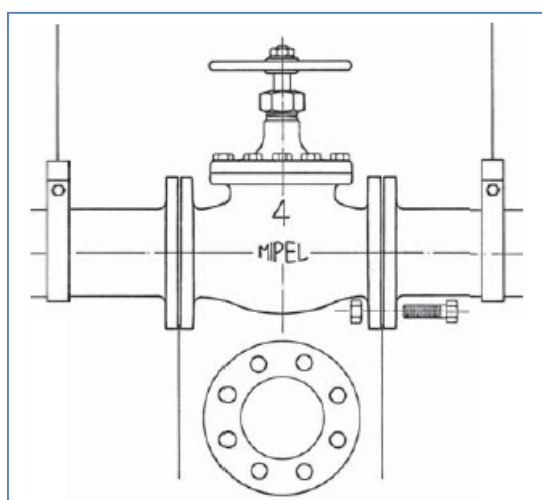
Válvula com extremidades com flanges - Detalhes de instalação
